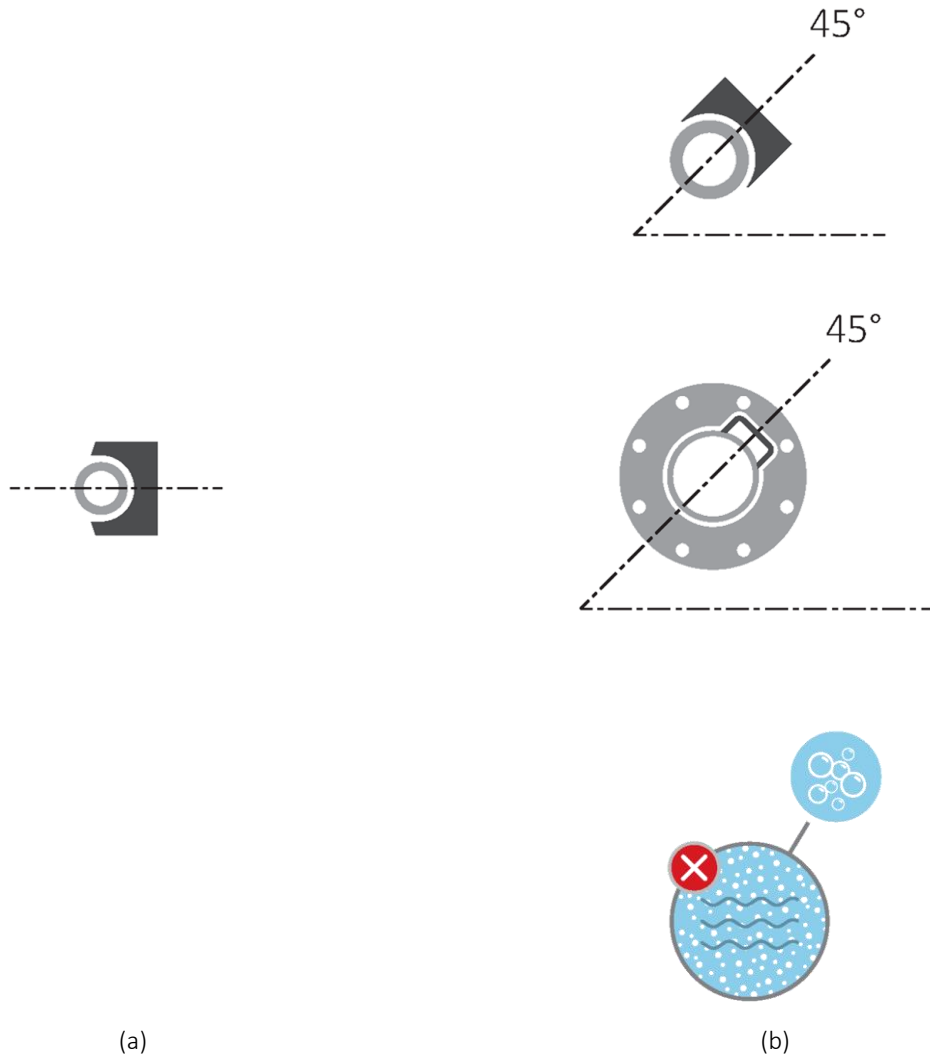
Empfohlene Orientierung der Kamstrup-Durchflusssensoren um die Rohrachse bei waagerechter Montage für Kälte- und kombinierte Wärme-/Kälteinstallationen. (a) Zählergehäuse mit Gewinde mit $q_p \leq 2,5 \text{ m}^3/\text{h}$. (b) Zählergehäuse mit Gewinde mit $q_p \geq 3,5 \text{ m}^3/\text{h}$ und Zähler mit Flansch.
